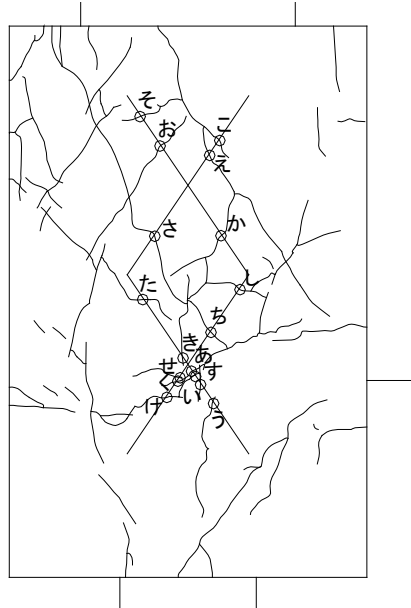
パイルキャップひび割れ幅測定位置 (試験体 A-6 負荷荷)
